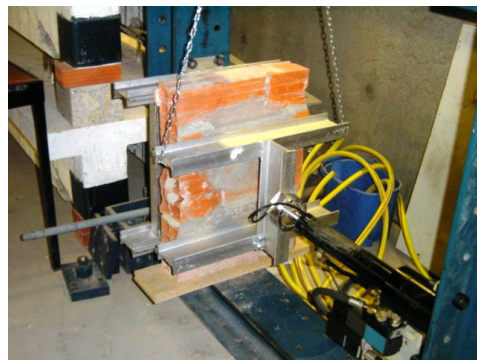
Provete aplicado na máquina de ensaio. Vista de topo
